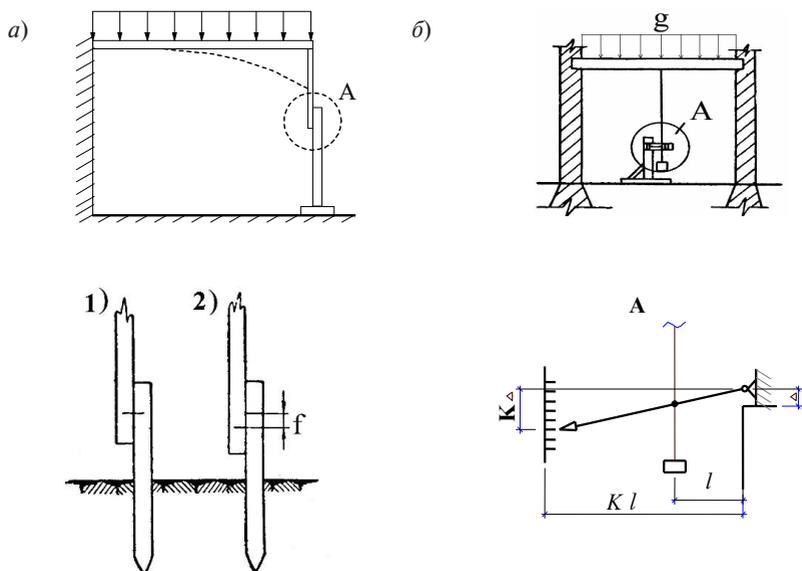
Простейшие приспособления для измерения прогибов: *a* — с помощью двух реек; *b* — рычажное устройство со стрелкой
